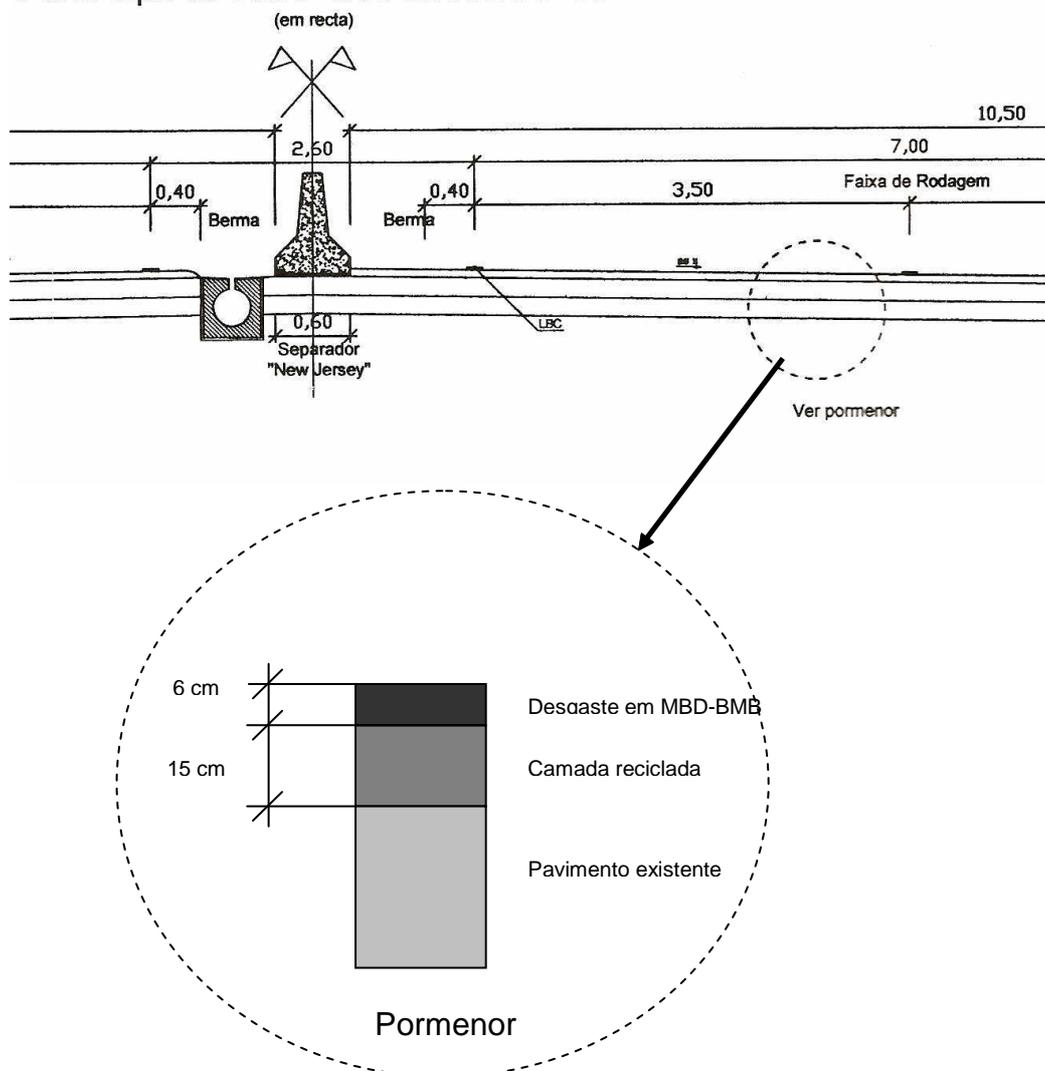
Representação do troço do IC12 e da estrutura final do pavimento (adaptado de Araújo, *et al*, 2008)
